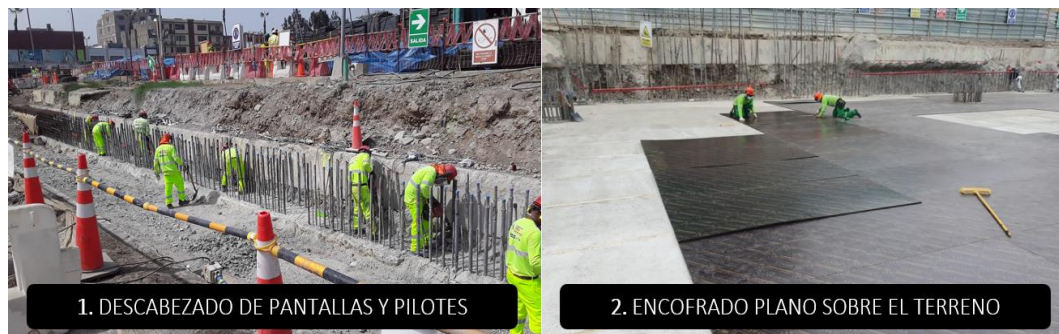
Proceso constructivo de la partida losa de cubierta (1-2).
